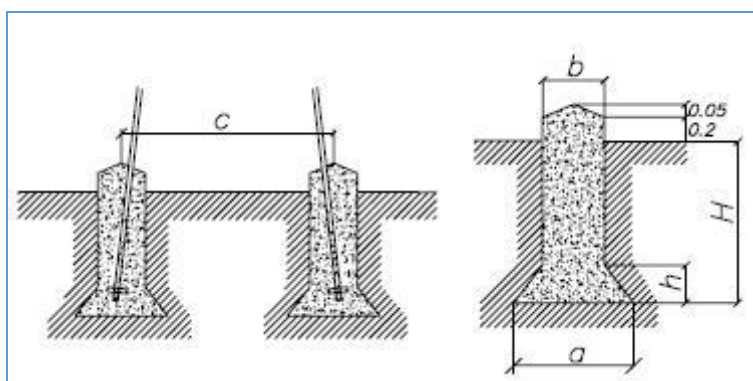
, Detalle cimentación tetrabloque cuadrada con cueva
